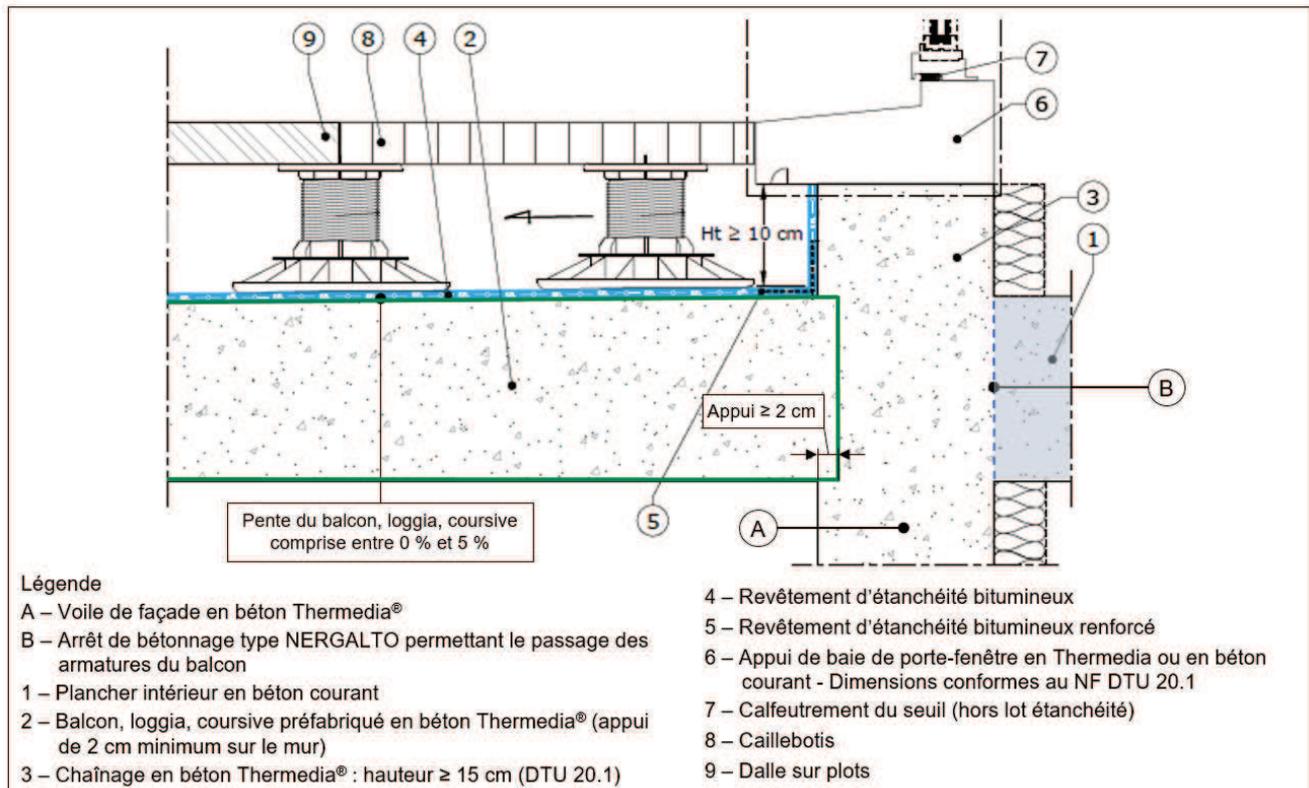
Exemple de balcon, loggia ou coursive préfabriqué avec étanchéité par un revêtement bitumineux avec protection par dalles sur plots - Seuil avec relevé de 10 cm de hauteur.
